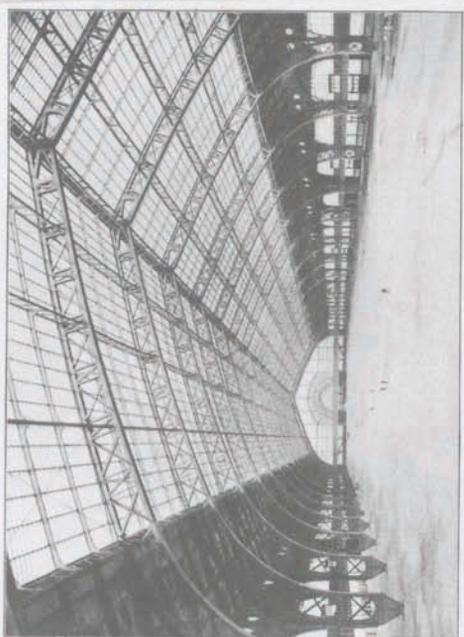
GALERIE DES MACHINES, PARIS 1889
